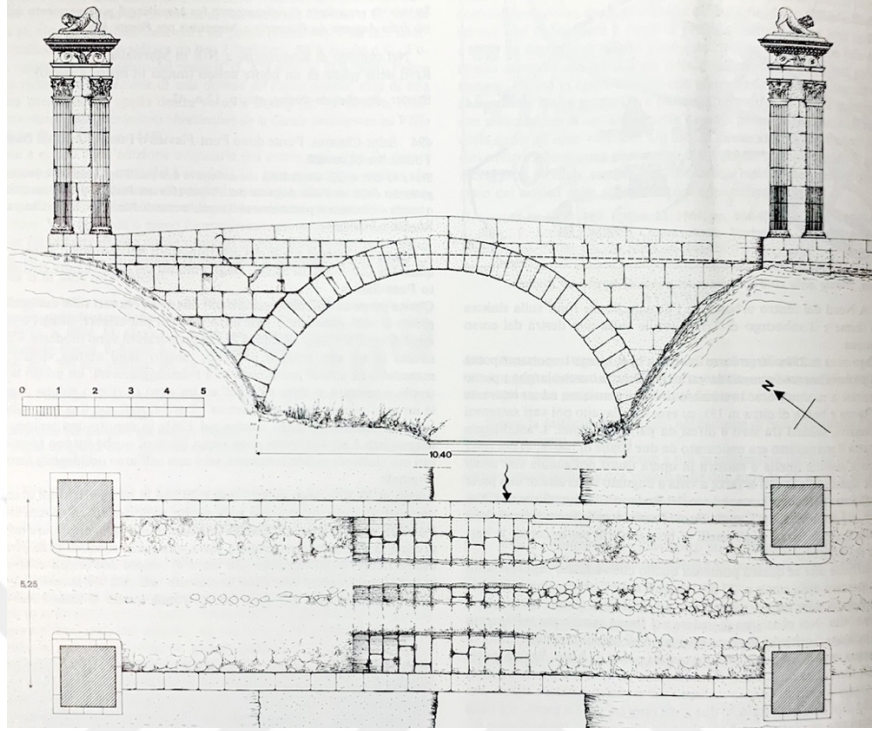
Cendere Köprüsü'nün parapetleri
